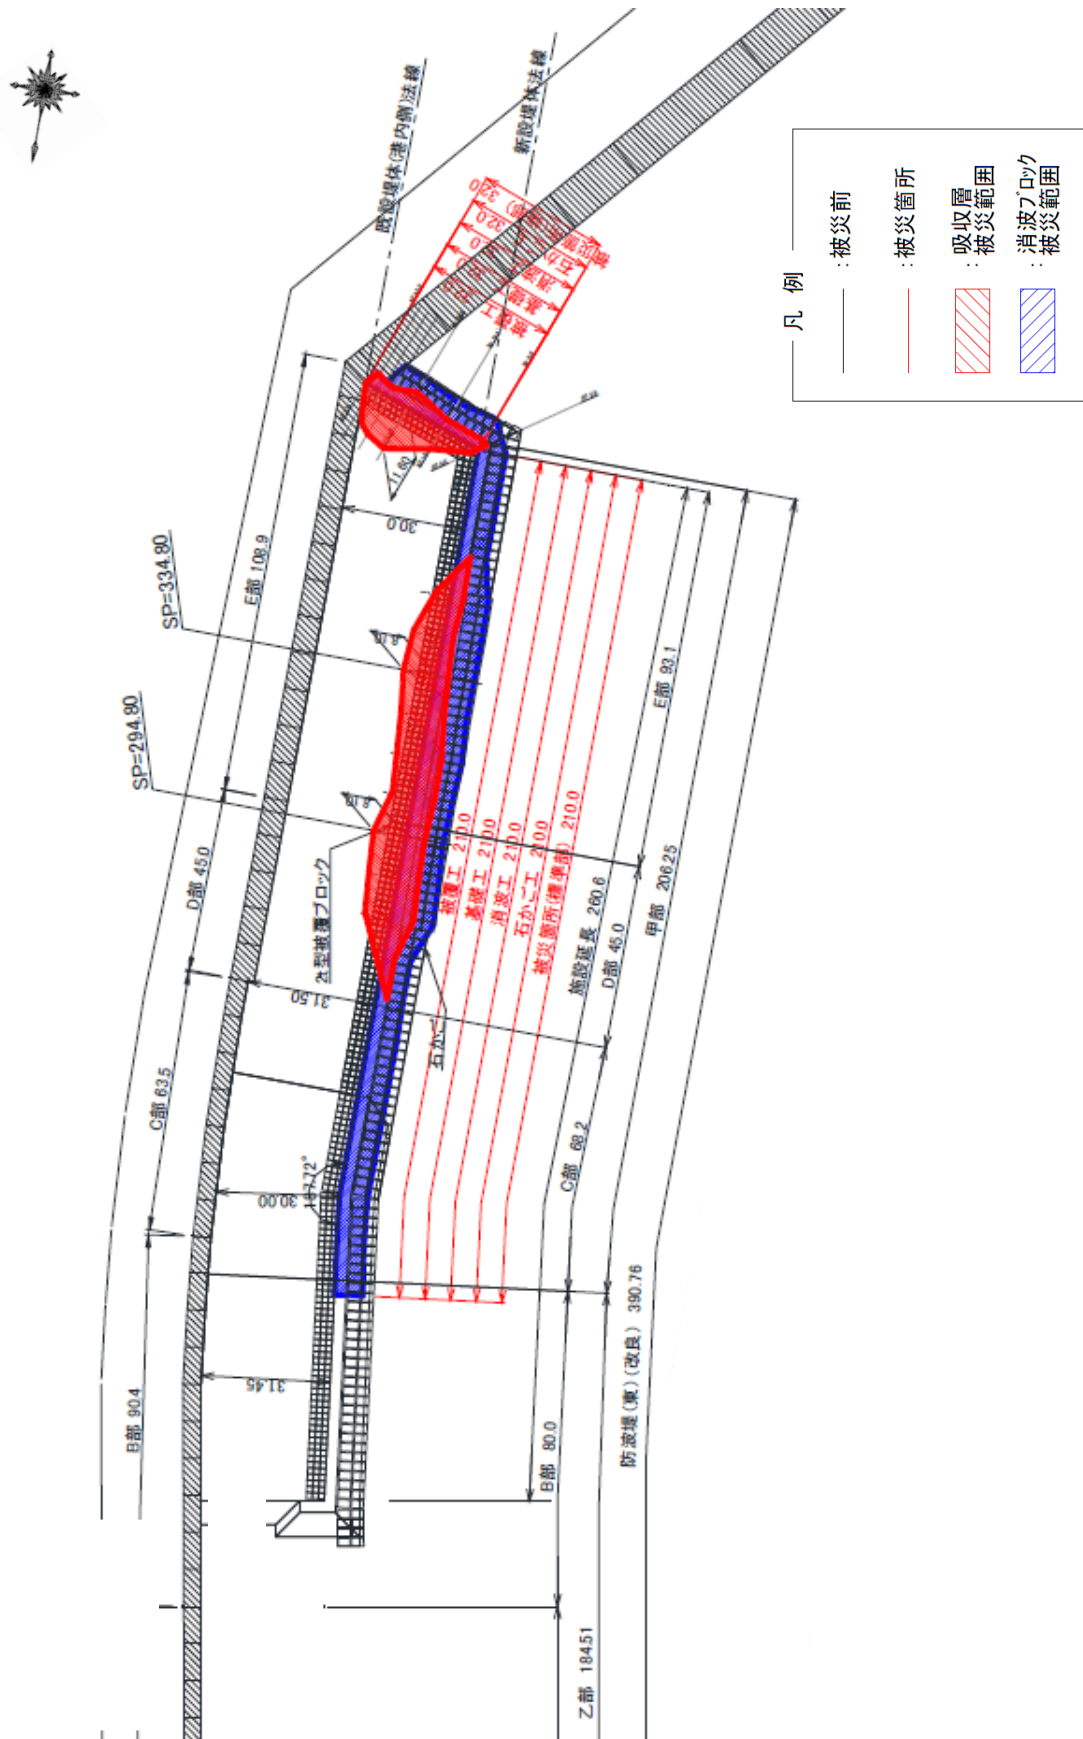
No.1 西港外港地区東防波堤の平面図(被災前・被災後)
